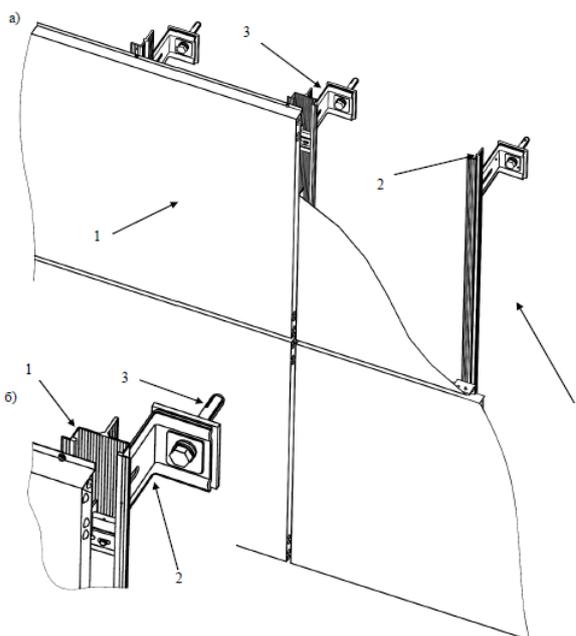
а – Общий вид конструкции навесного вентилируемого фасада. 1 – навесные панели (кассеты); 2 – ограждающая конструкция (не показана); 3 – узел крепления; 4 – вертикальная направляющая;
